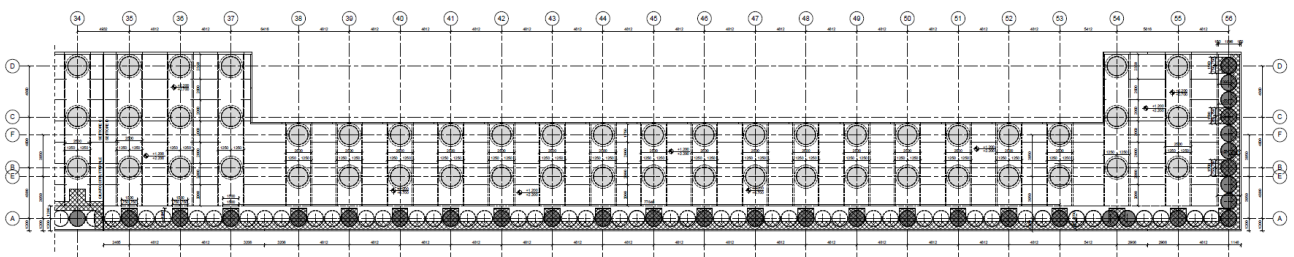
PE: Settore D – pianta fondazioni – stralcio.
